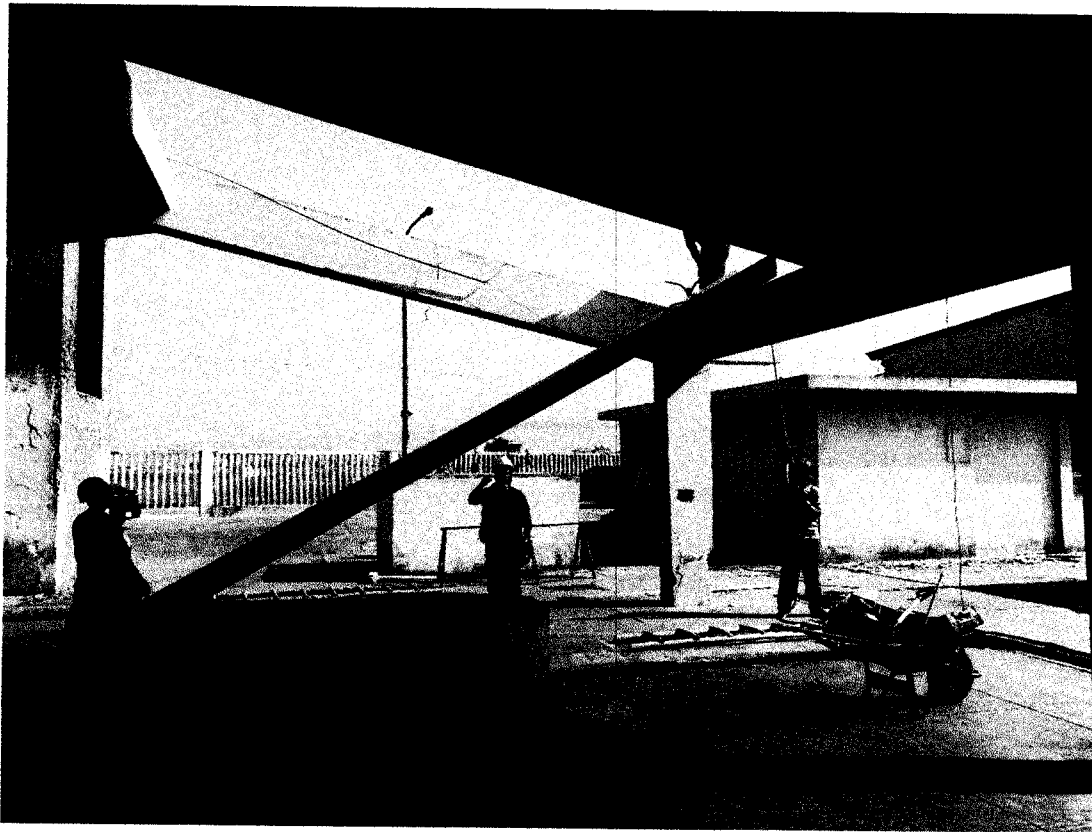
Desmontaje de techo de Fibro cemento en talleres de visera do y distribución del pescado.
